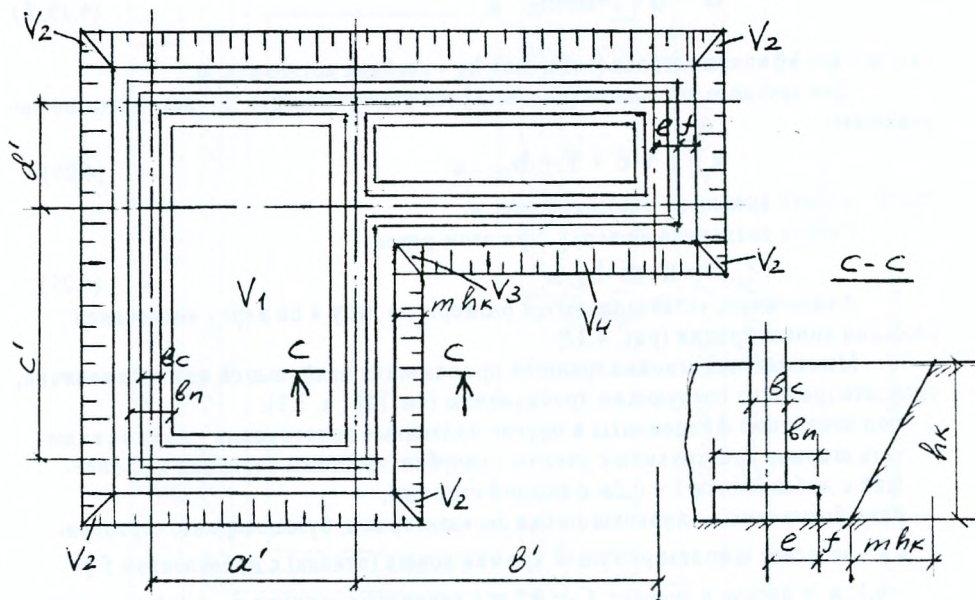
Схема котлована сложной формы со сборным фундаментом
